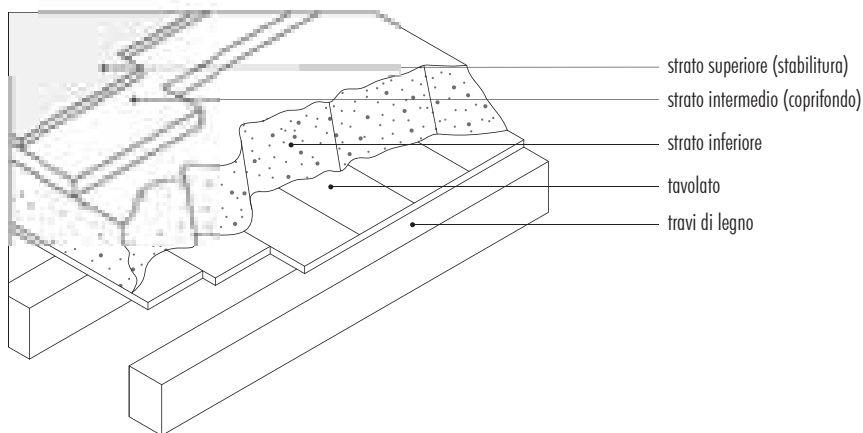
\_Stratificazioni di una pavimentazione tradizionale tipo in cocchiopesto.
